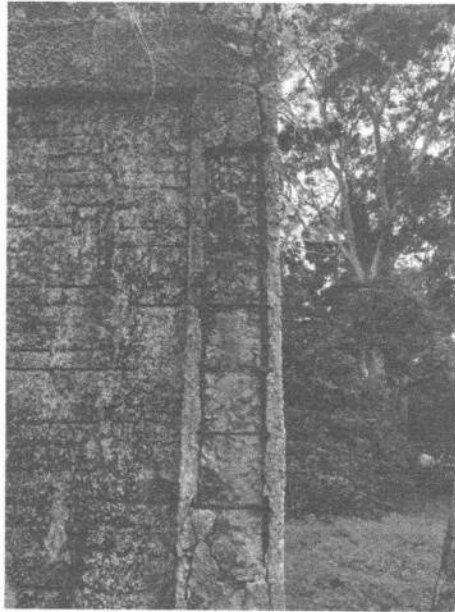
Armadura longitudinal e estribos expostos em um dos pilares, com presença de corrosão e concreto com vida útil comprometida, apresentando deslocamento.
